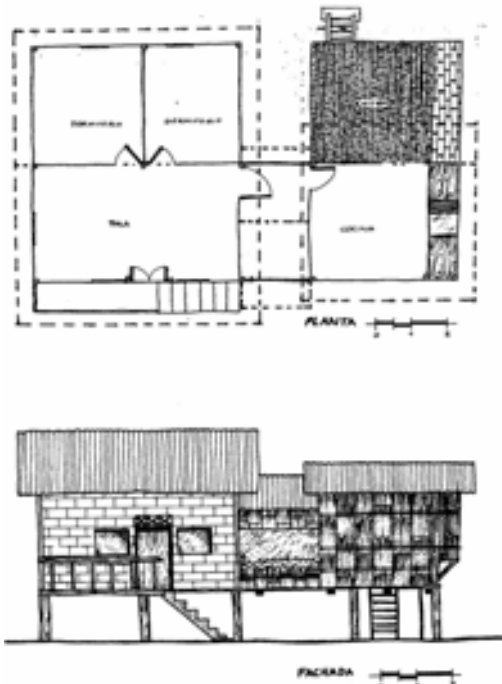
Esquema de casa em bambu na Colômbia, planta baixa e elevação frontal.
